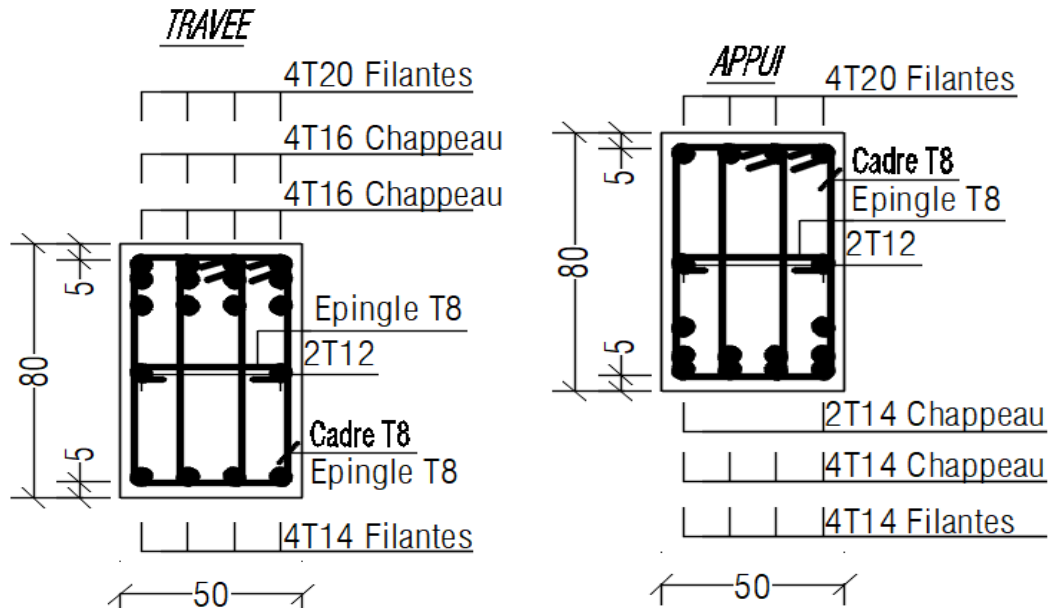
Schéma de ferrailage des nervures (sens porteur).
